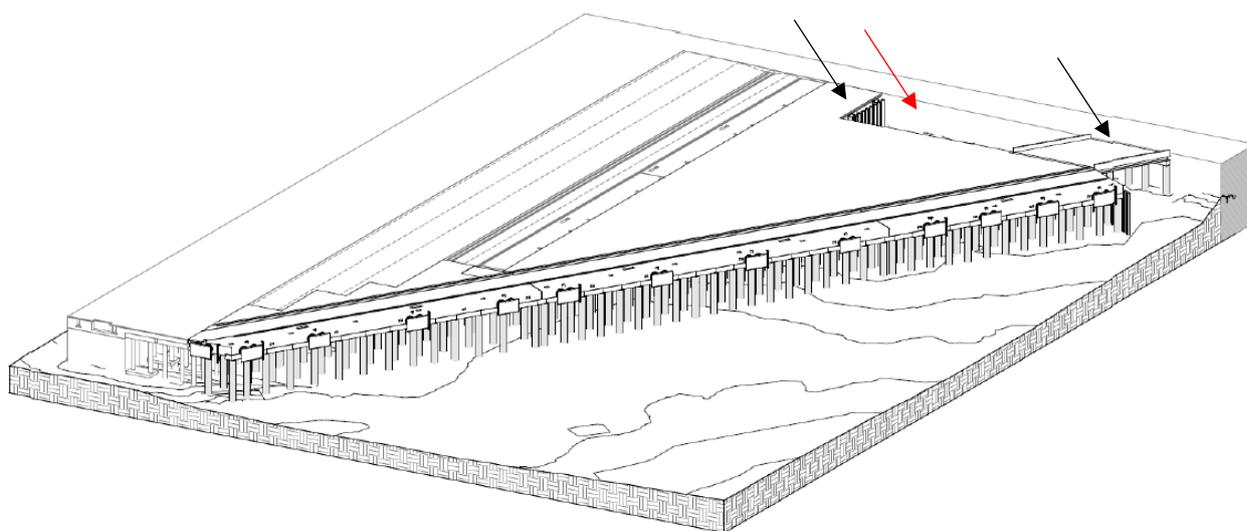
Vista prospettica dell'opera D; sono evidenziati i due punti di connessione con la banchina esistente a nord e la posizione dello sbocco del torrente Cantarena (freccia rossa)
